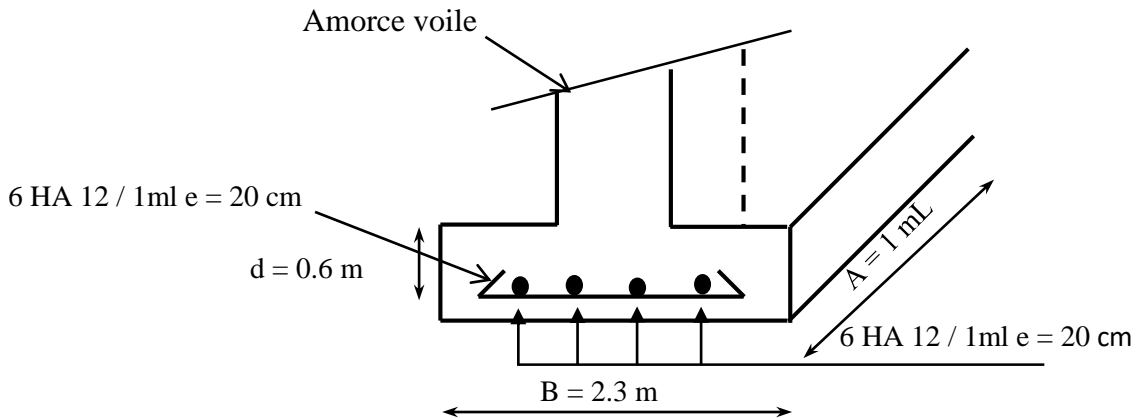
Le schéma de ferrailage d'un semelle fillante
